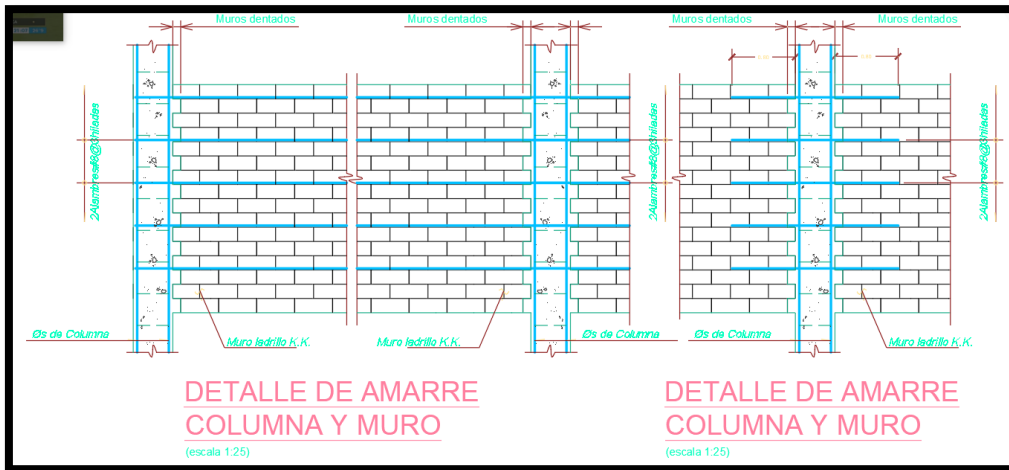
Se aprecia detalle de colocación de alambre de muros de albañilería.
